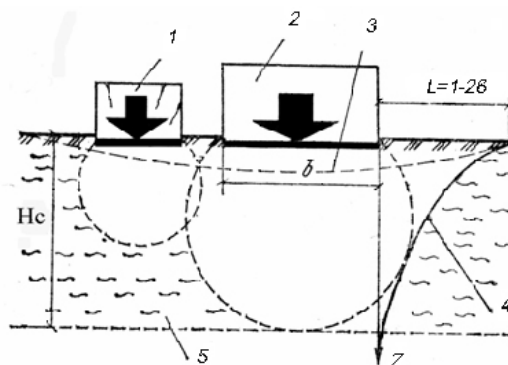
Осадка поверхности грунта: 1 – существующее здание; 2 – возводимое здание; 3 – воронка оседания; 4 – эпюра осадки; 5 – сильносжимаемый грунт
